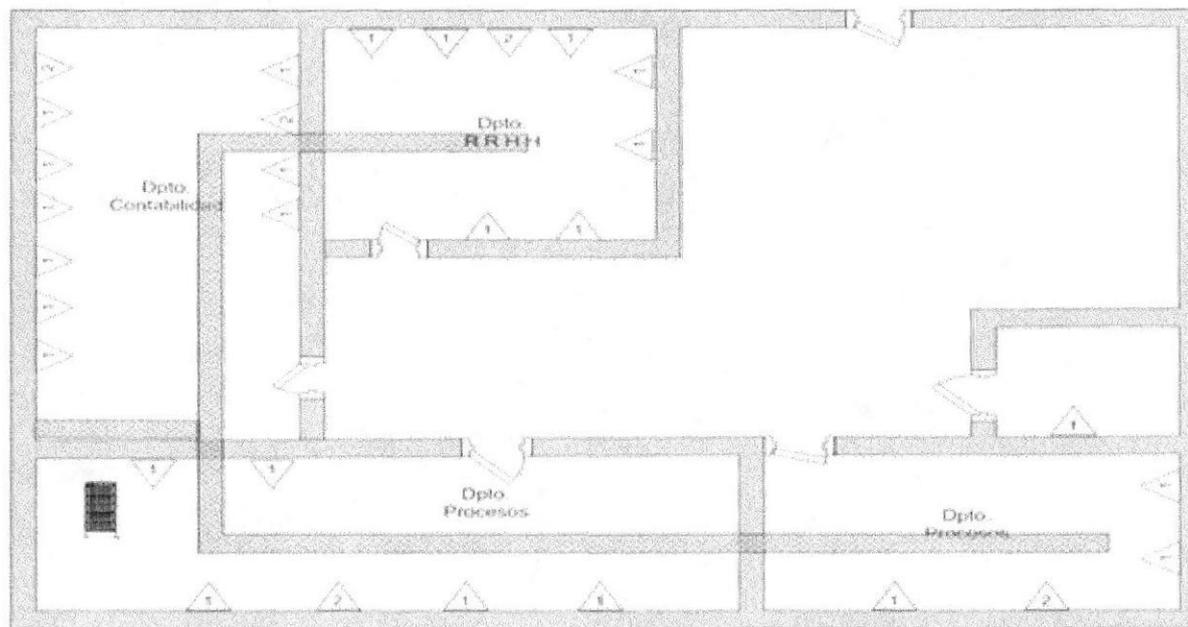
Análisis de Piso Aplicativo Segunda Planta
